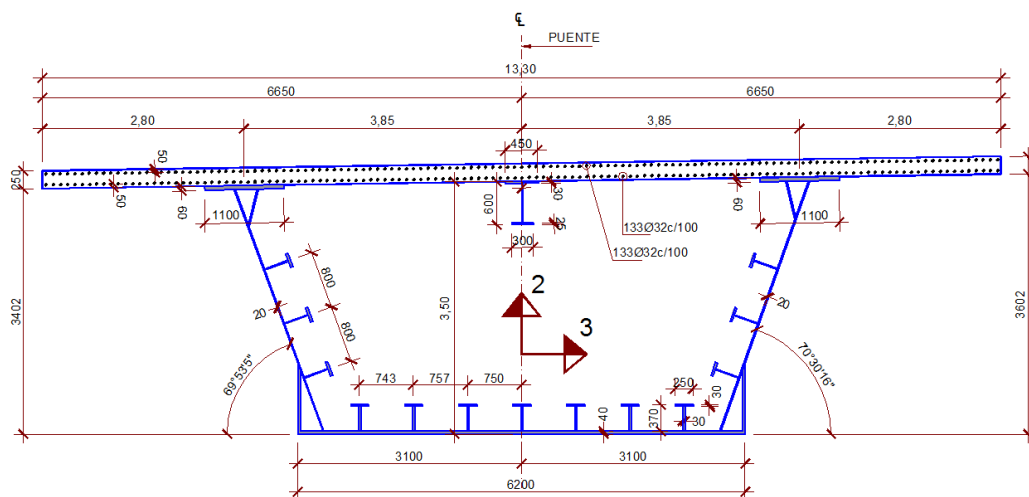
Geometría de la sección transversal del puente en soprtes (Fuente: Elaboración propia)
